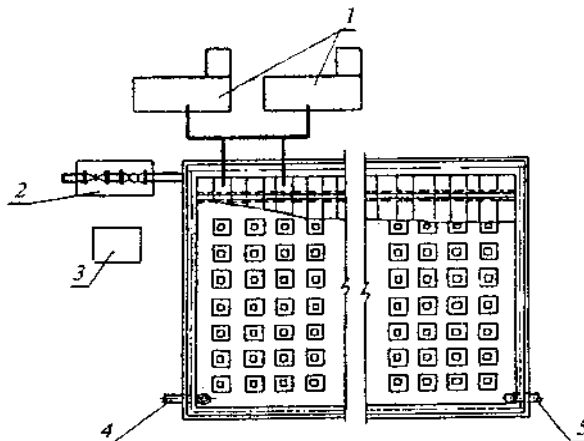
Схема забора воды мотопомпами из резервуаров, оборудованных фильтрами-поглотителями
